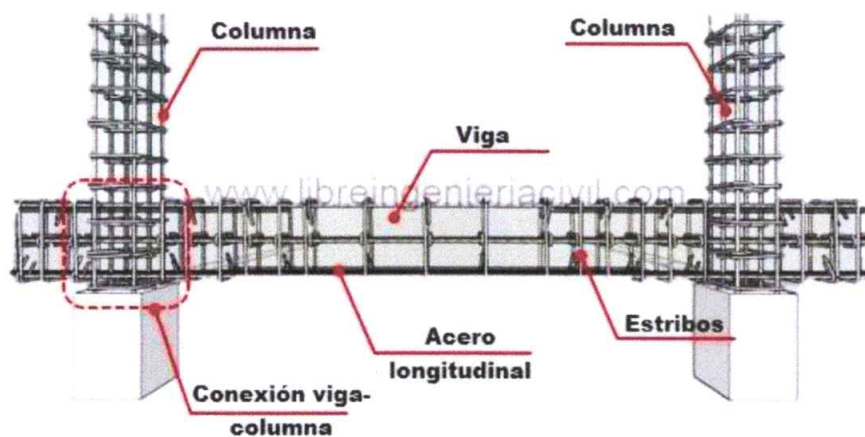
Esquema de viga. Fuente: Libre Ingeniería civil (2021)
